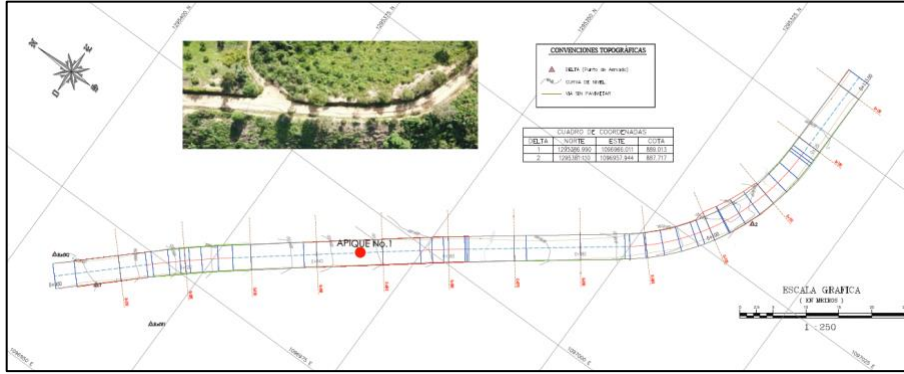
Imagen de planta del tramo 6 del proyecto de Rionegro-Santander
